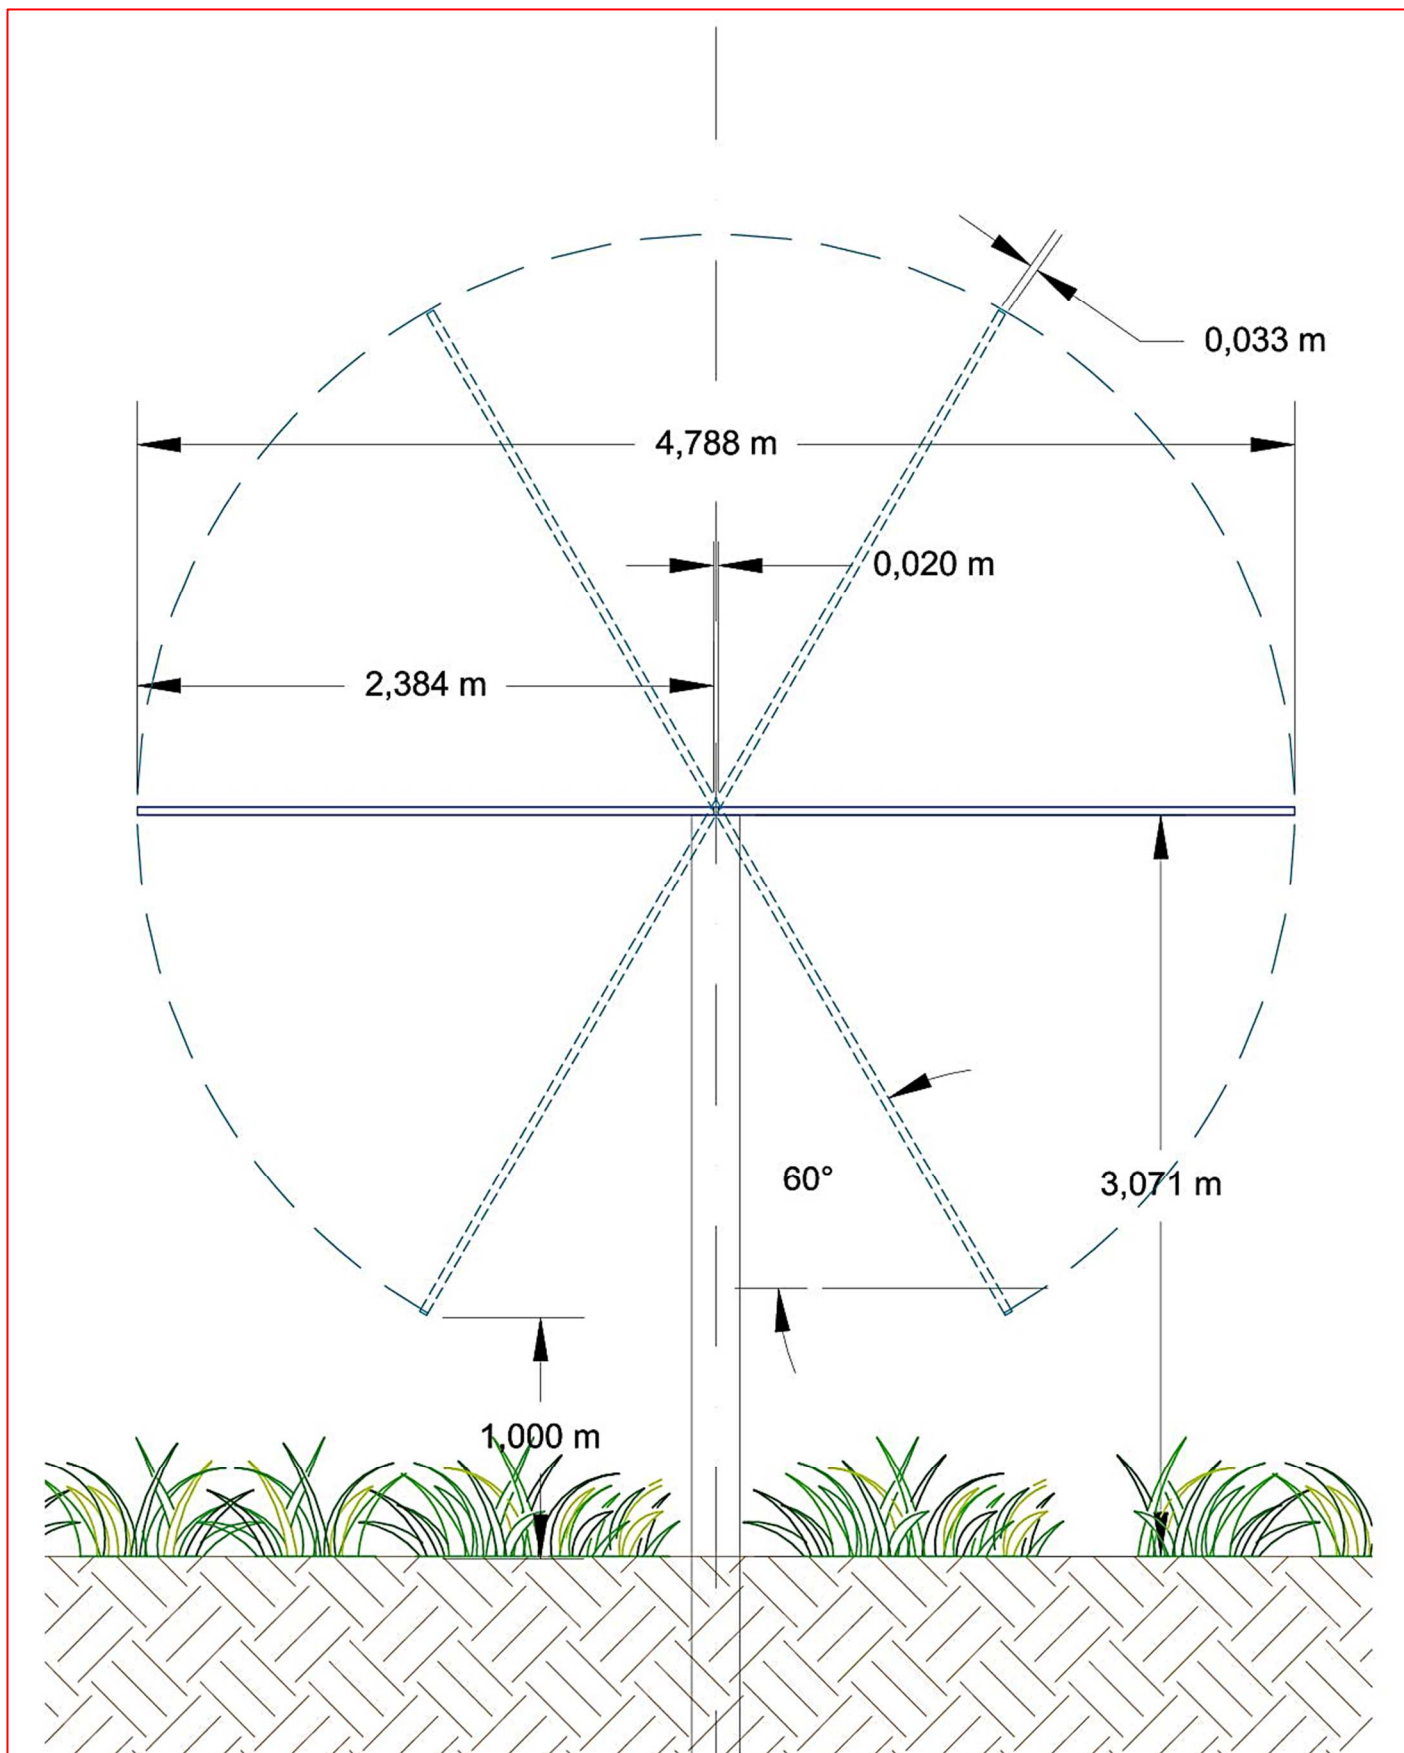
Layout complessivo dell'impianto – Fuori scala
